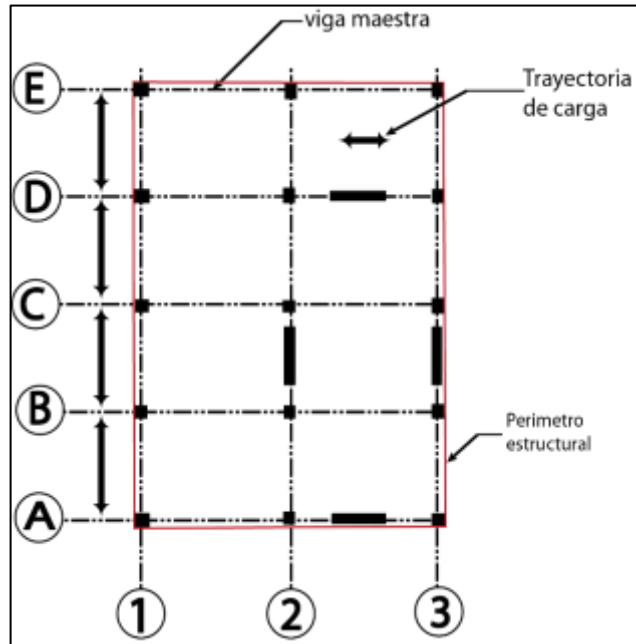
Trayectoria de cargas en la estructura; Fuente: [Grupo investigador]
